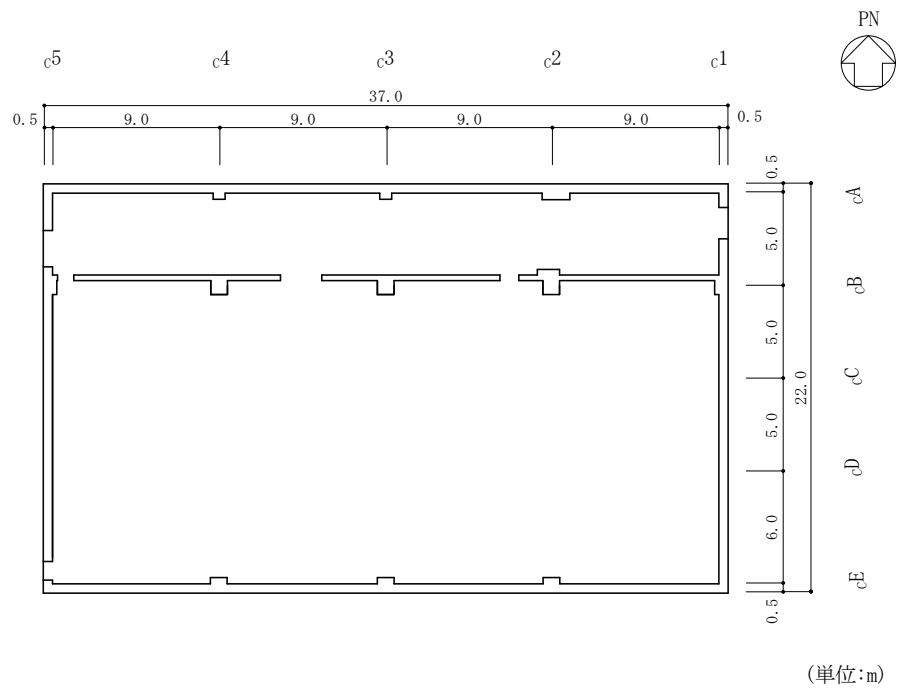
制御室建物の概略平面図 (EL 16.9m)
